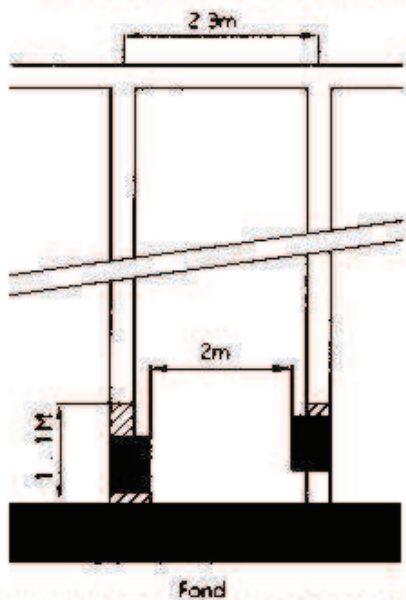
Places de classes A - Application des tableaux 2 et 3 à un rangement en bataille
